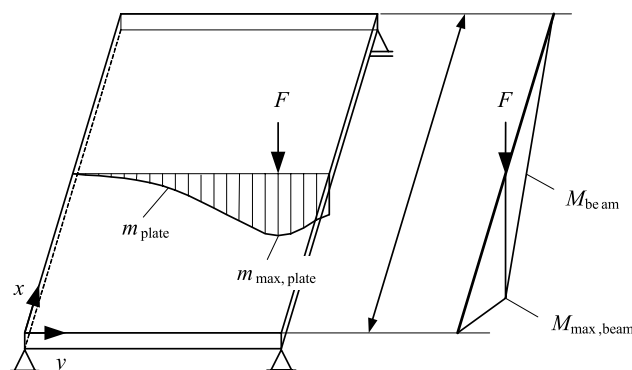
Схема распределения изгибающего момента в плите для определения рабочей ширины согласно СН РК EN 1995-2:2004/2011
